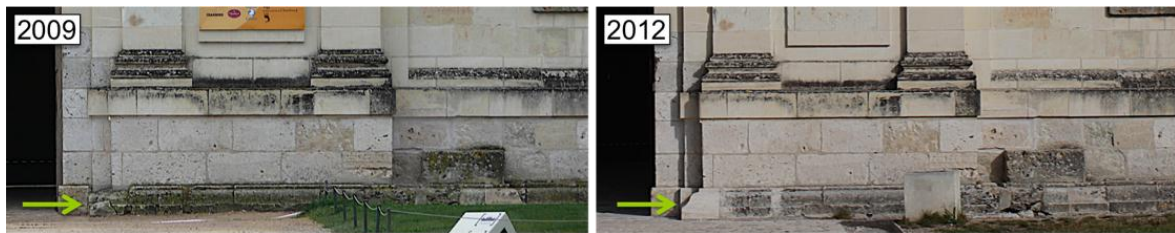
REMPLACEMENT D'UNE PIERRE SUR LE JAMBAGE DE DROITE DU PORTAIL ROYAL
